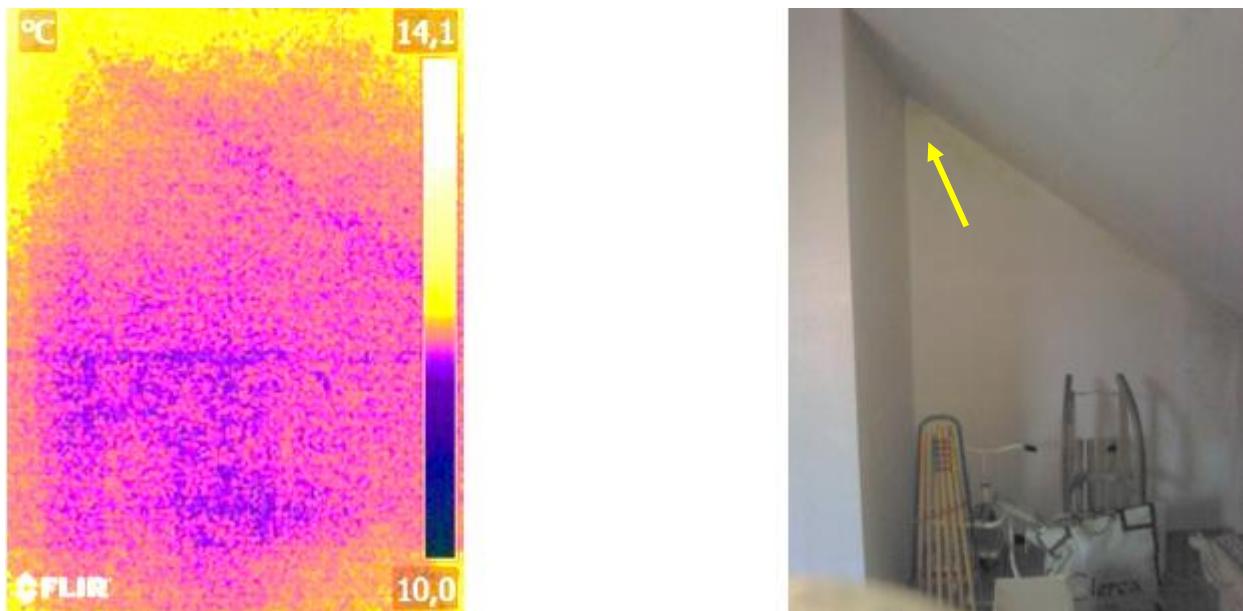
local dénommé grenier sur le plan (façade orientée NO)
